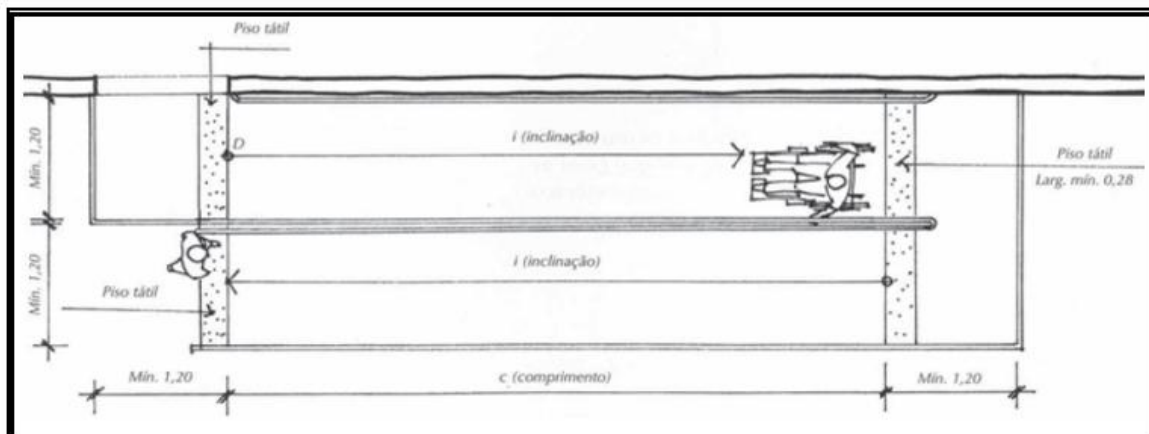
Circulação Vertical. Vista superior da rampa.
